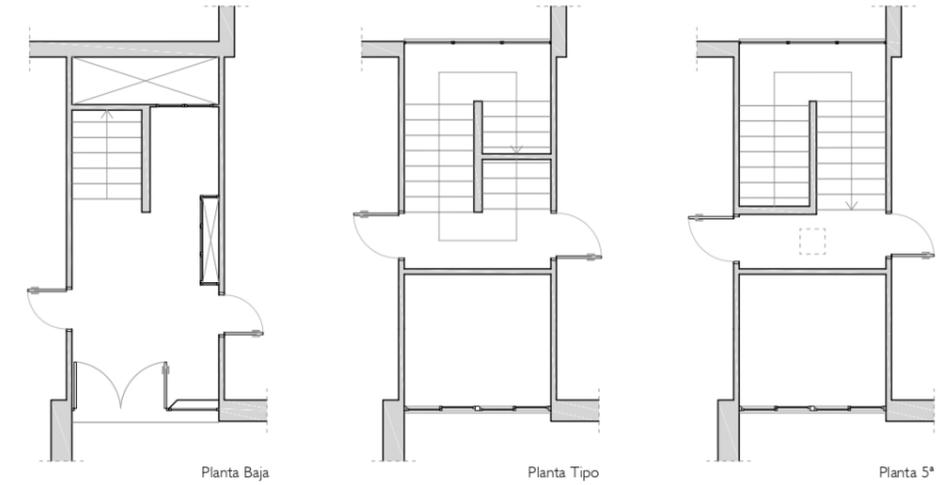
Plantas núcleo de escaleras Tipo 2.
